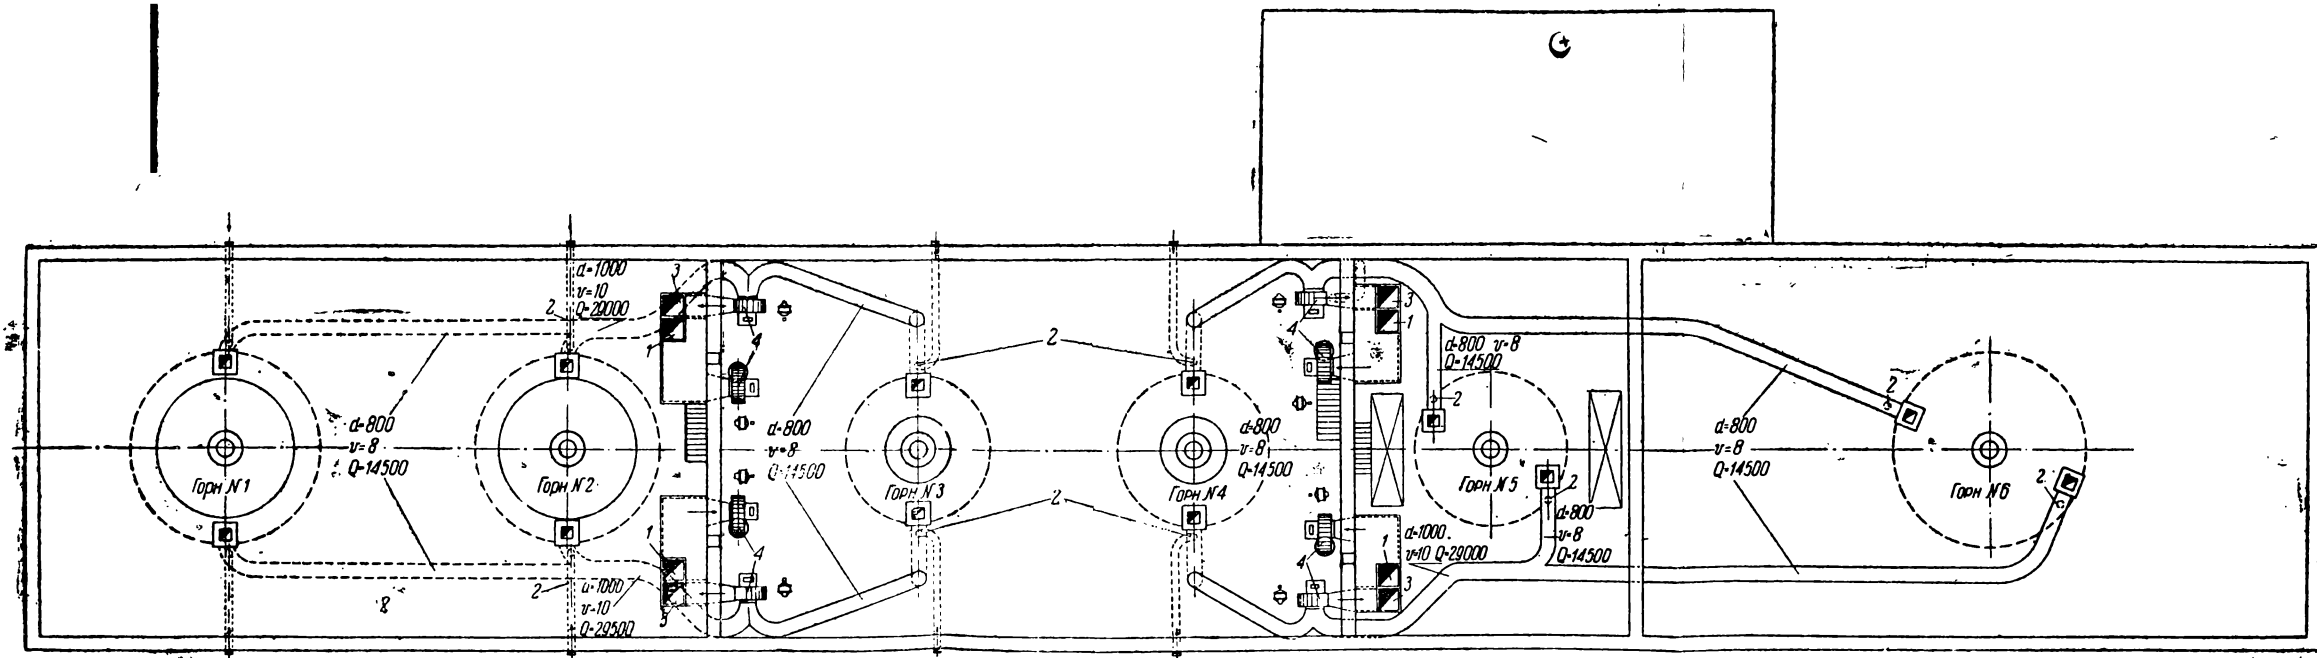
Искусственная вентиляция для охлаждения круглых горнов (план установок).
